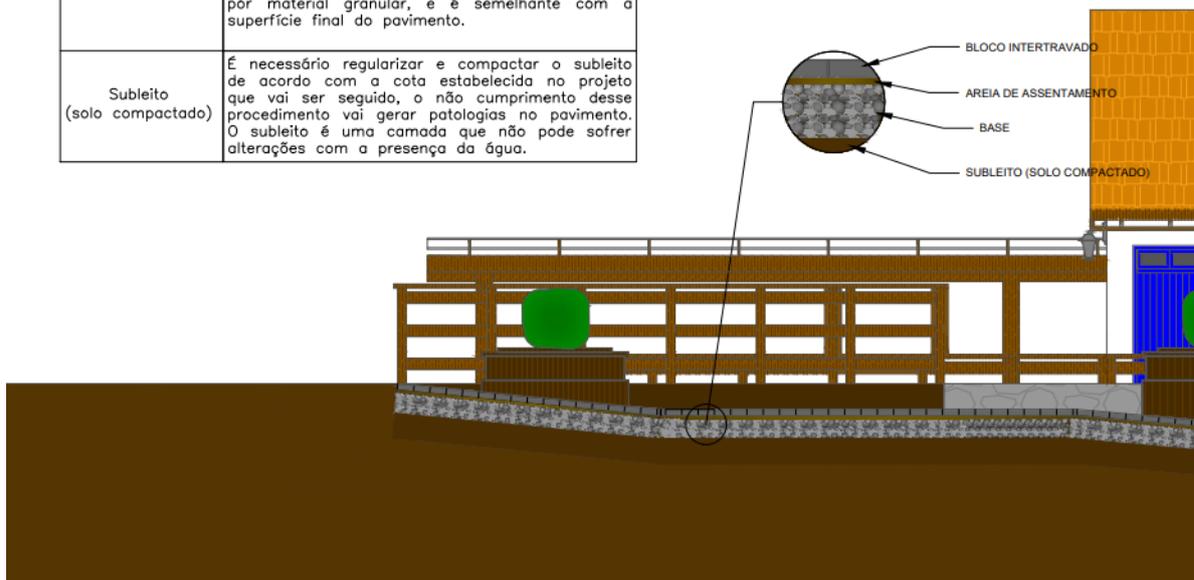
Detalhamento do Wood Frame e do Deck de Madeira
